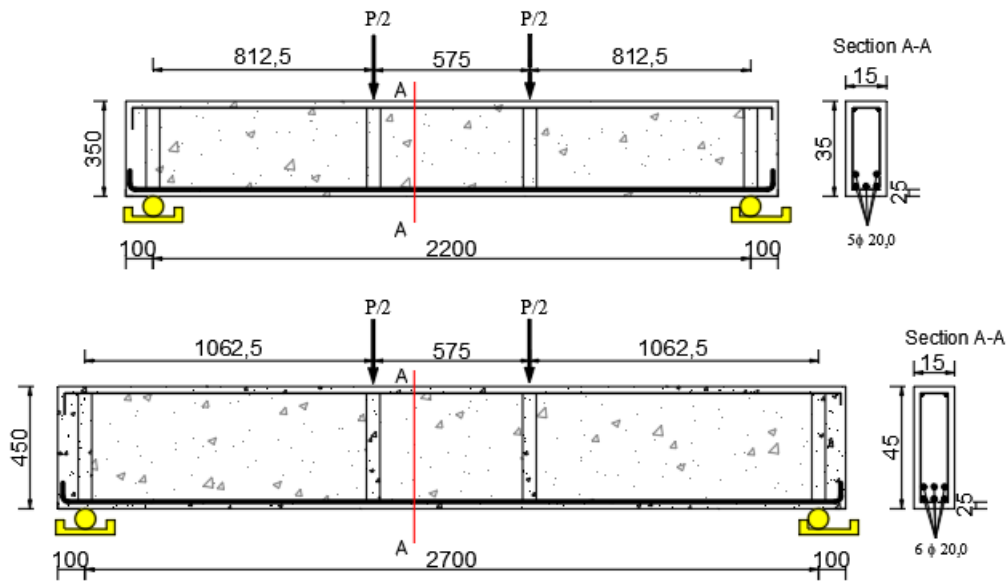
Configuração geométrica e pontos de aplicação de carga em todas as vigas.
